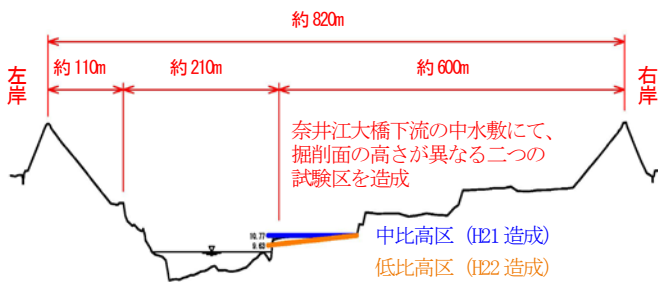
KP76.5地点の横断面図と各比高区の横断面の重ね図
